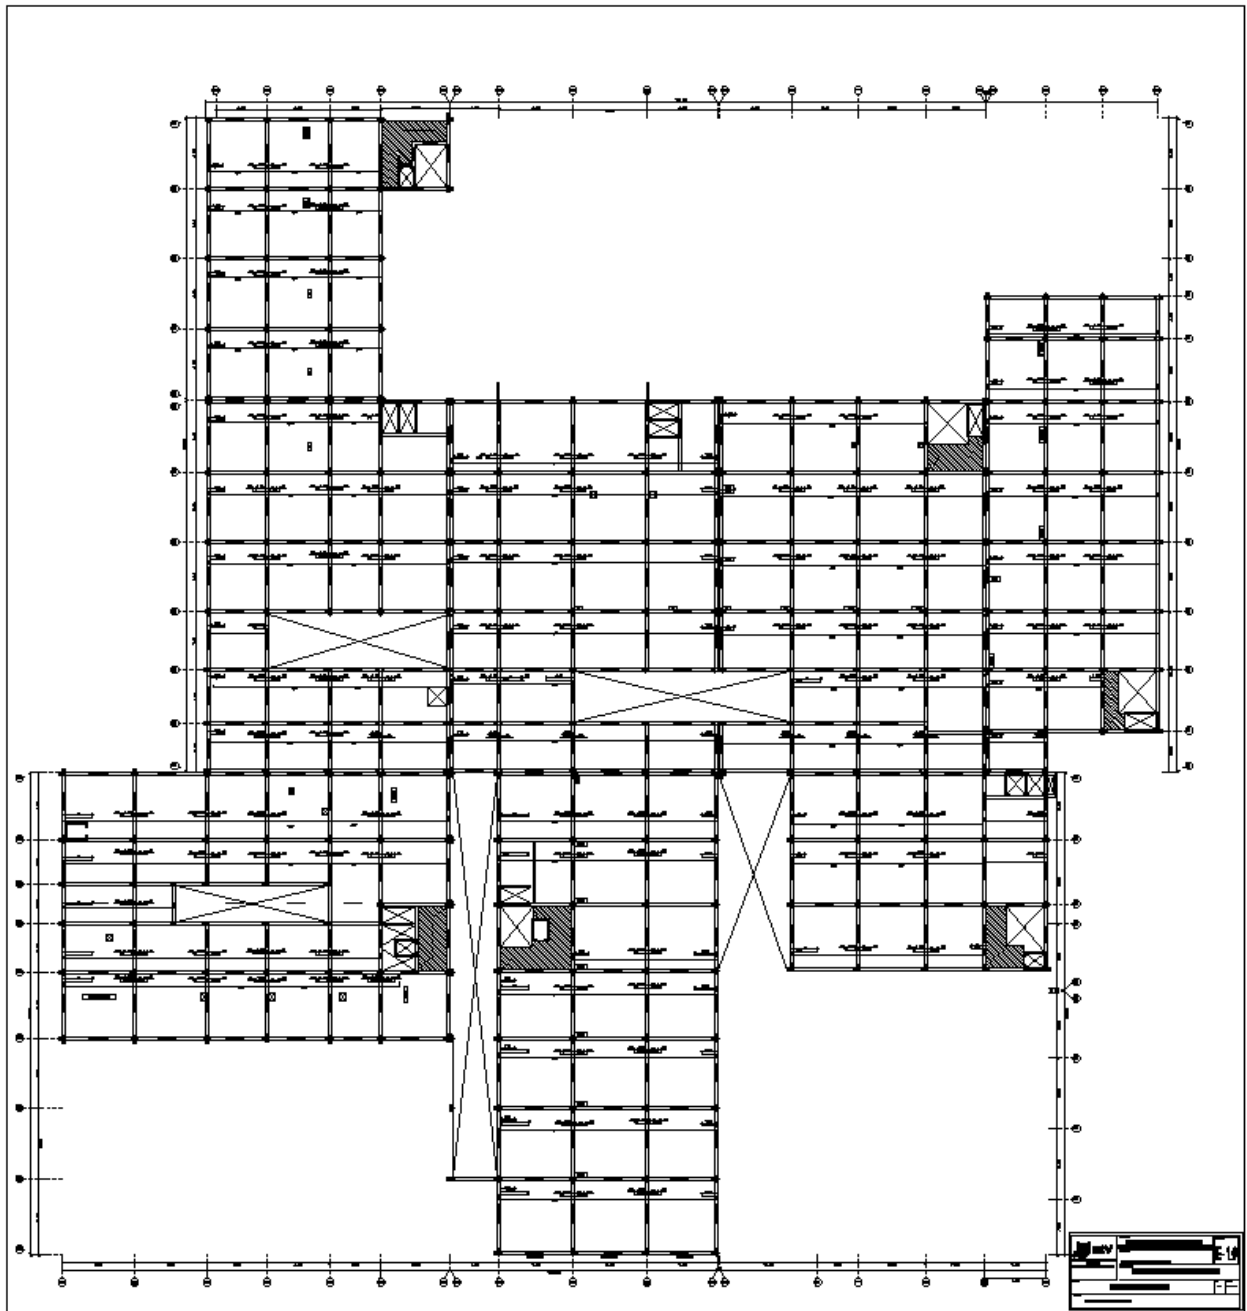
Plano de estructuras – techo típico aligerado 2º, 3º y 4º nivel
